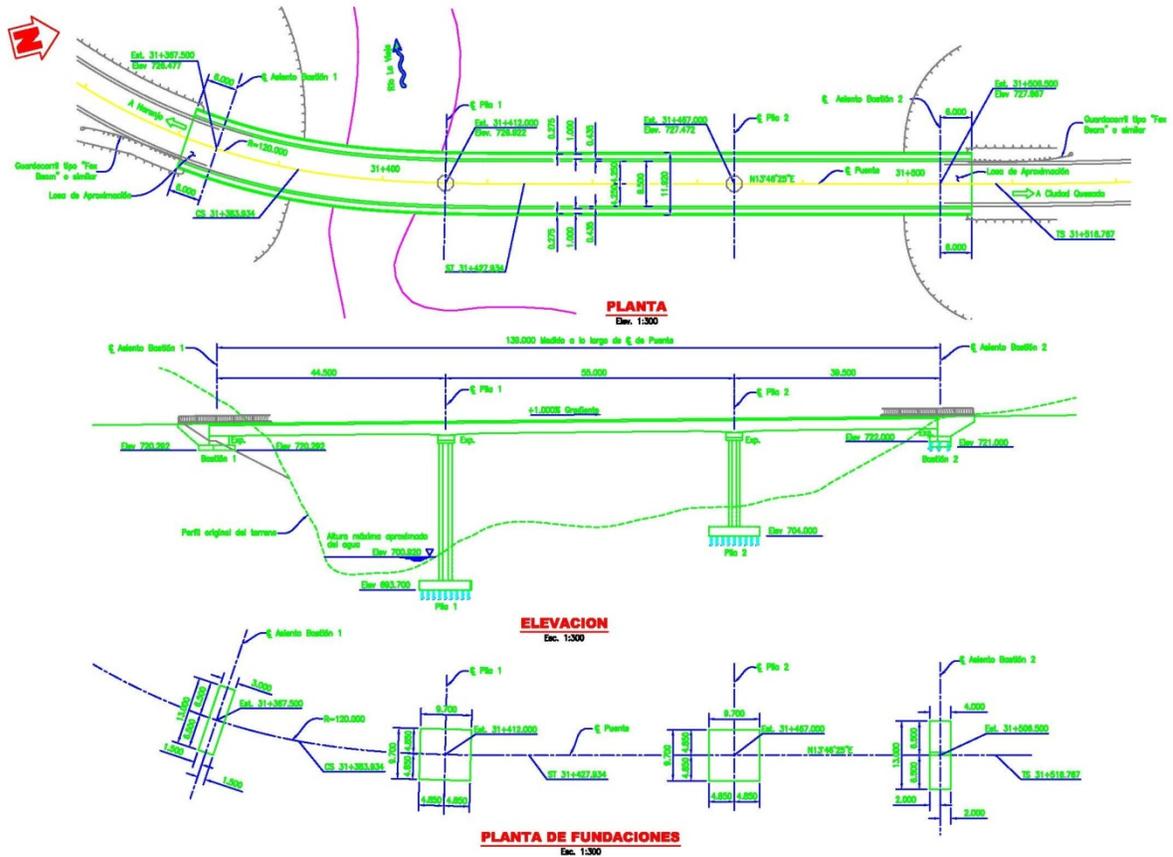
Plano sobre el puente sobre el Río La Vieja donde se identifican sus elementos.
